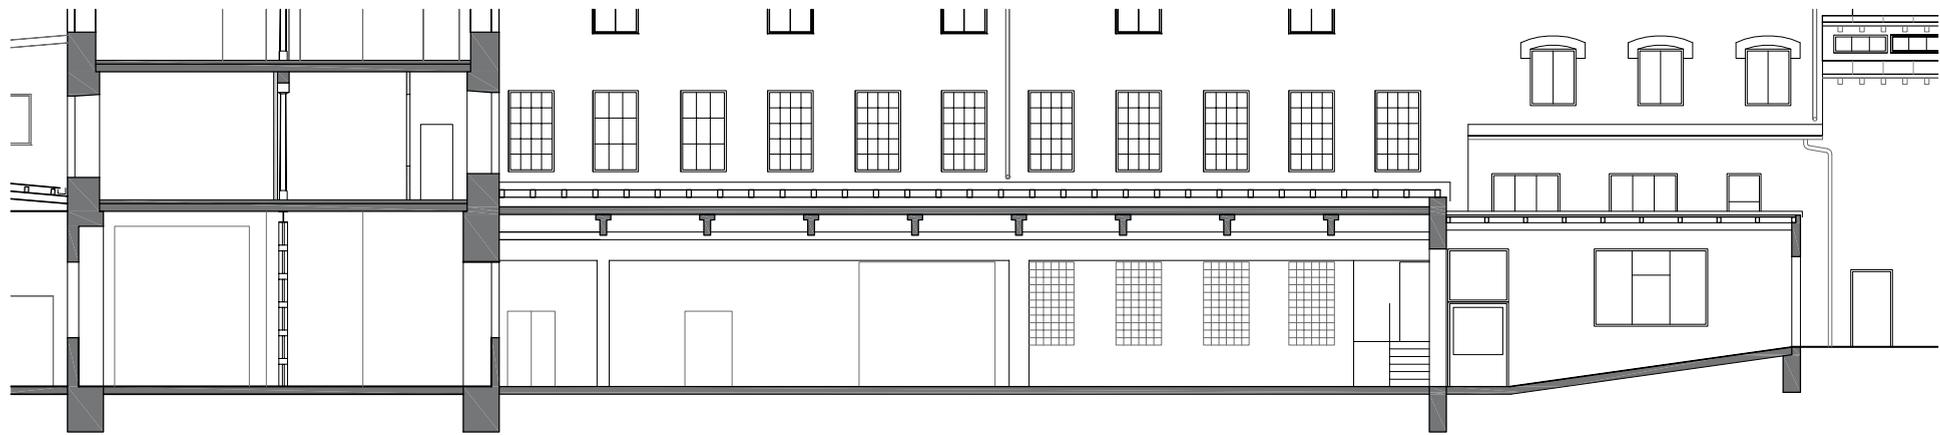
Halle (Blick zur Hoffassade und Eingang mit Rampe)
